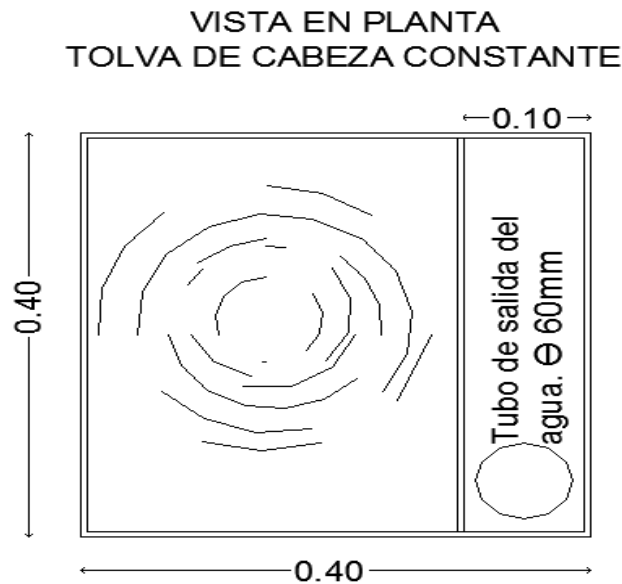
Vista en planta de la tolva de cabeza constante y el vertedero de excesos.
